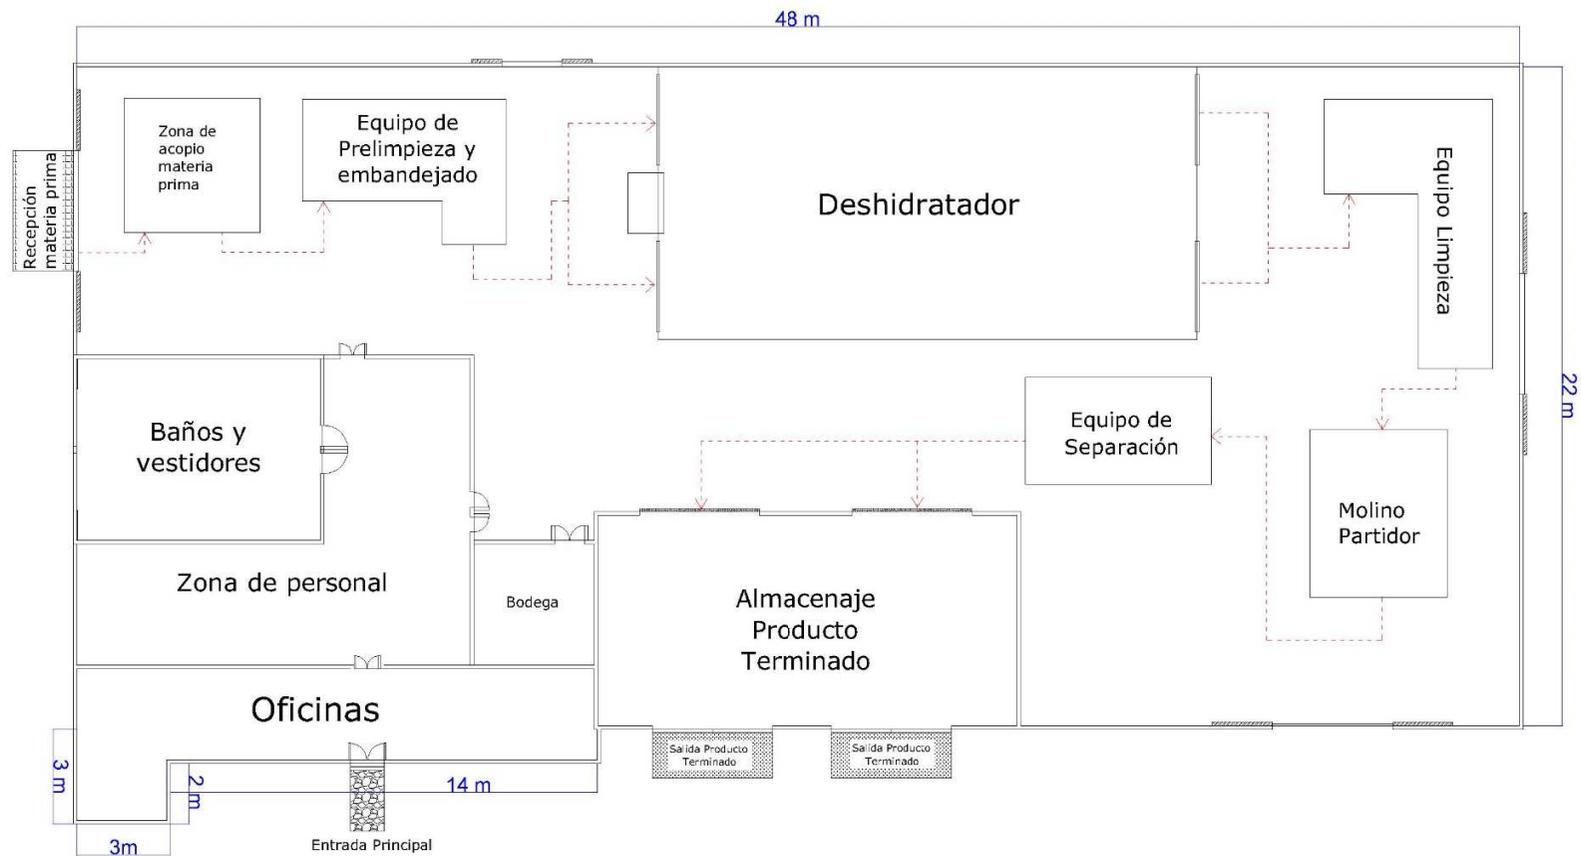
Layout de la planta procesadora de rosa mosqueta (Escala aproximada 1:200) Fuente: Elaboración Propia
